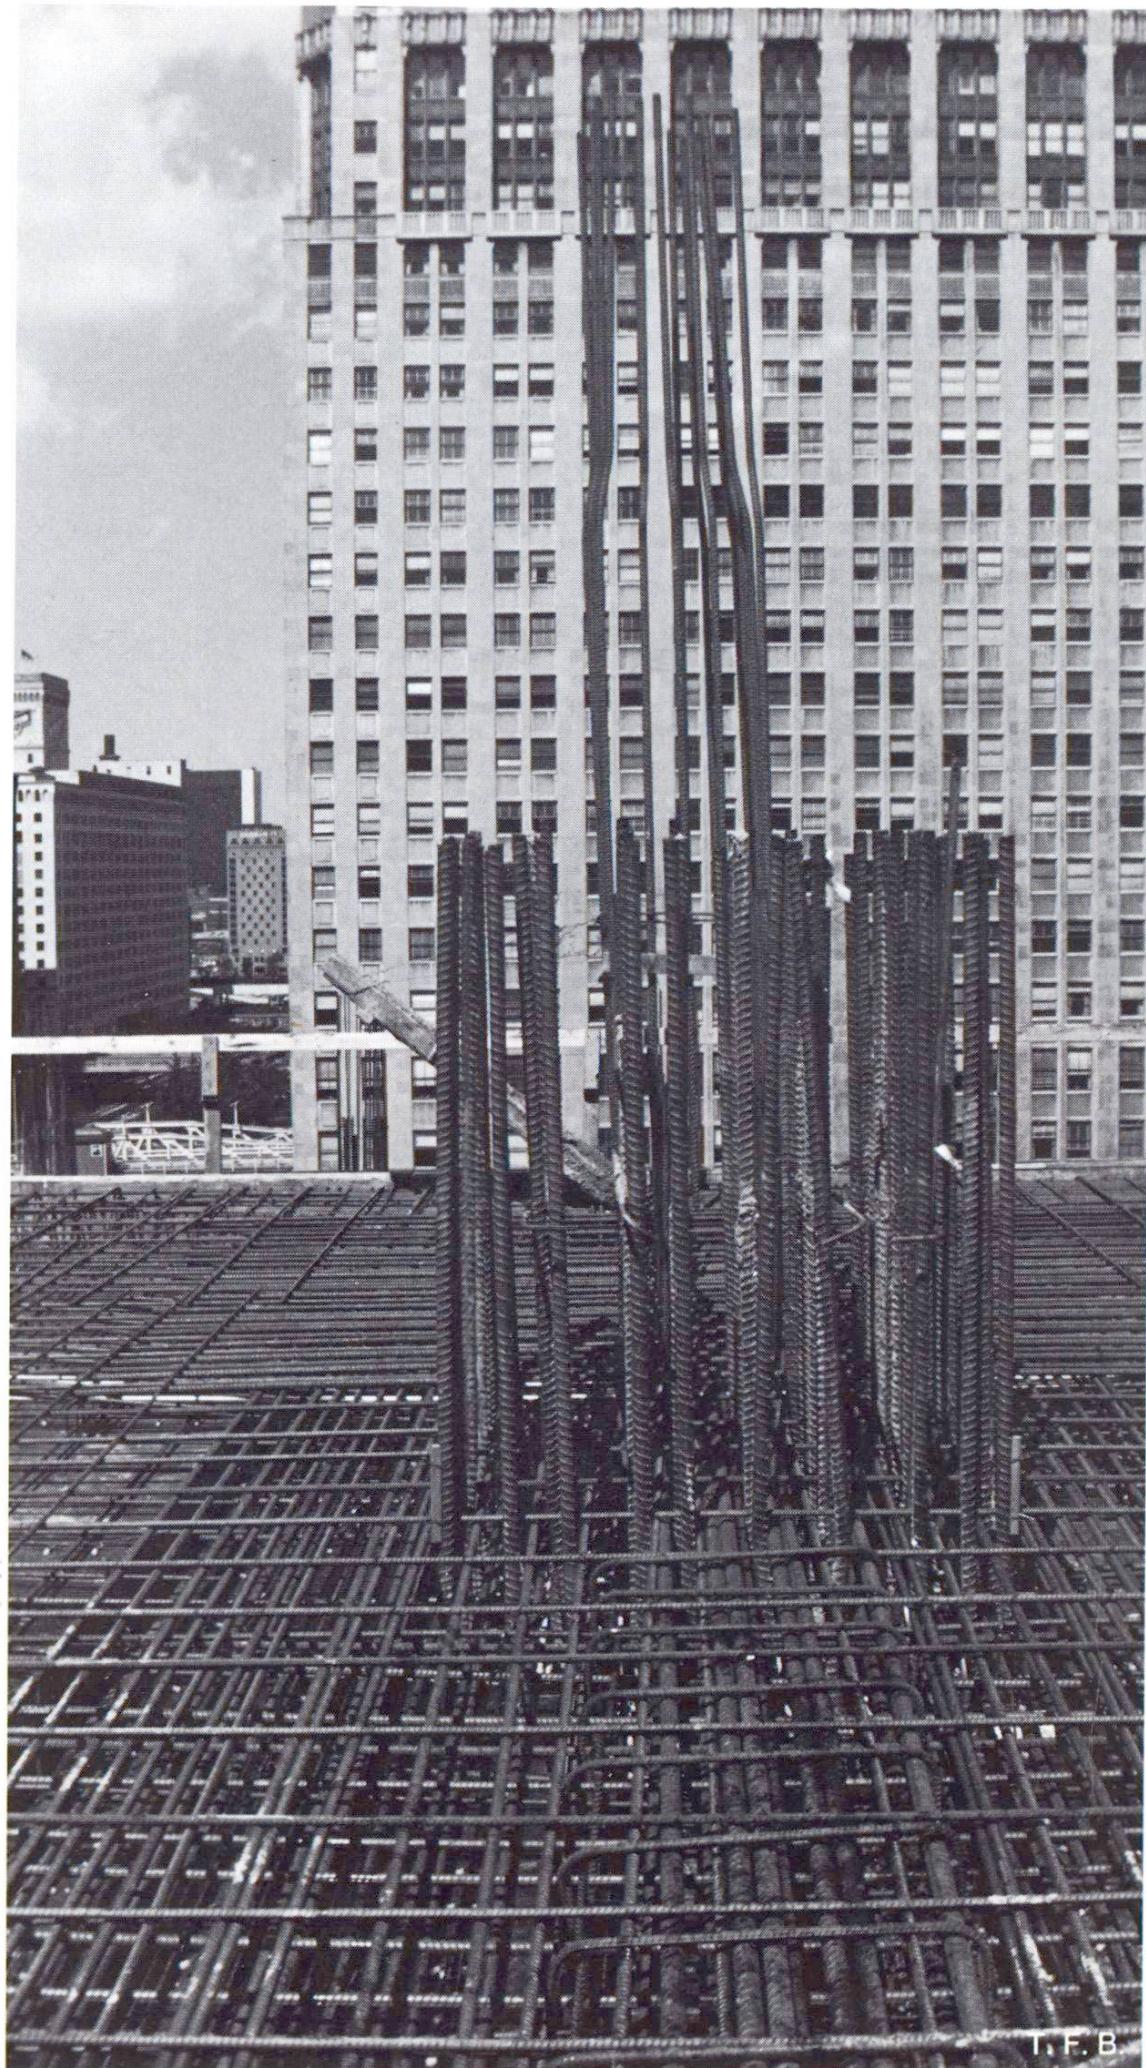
Armature d'un pilier principal et de la traverse qui le relie à la paroi intérieure au 9<sup>e</sup> étage.
